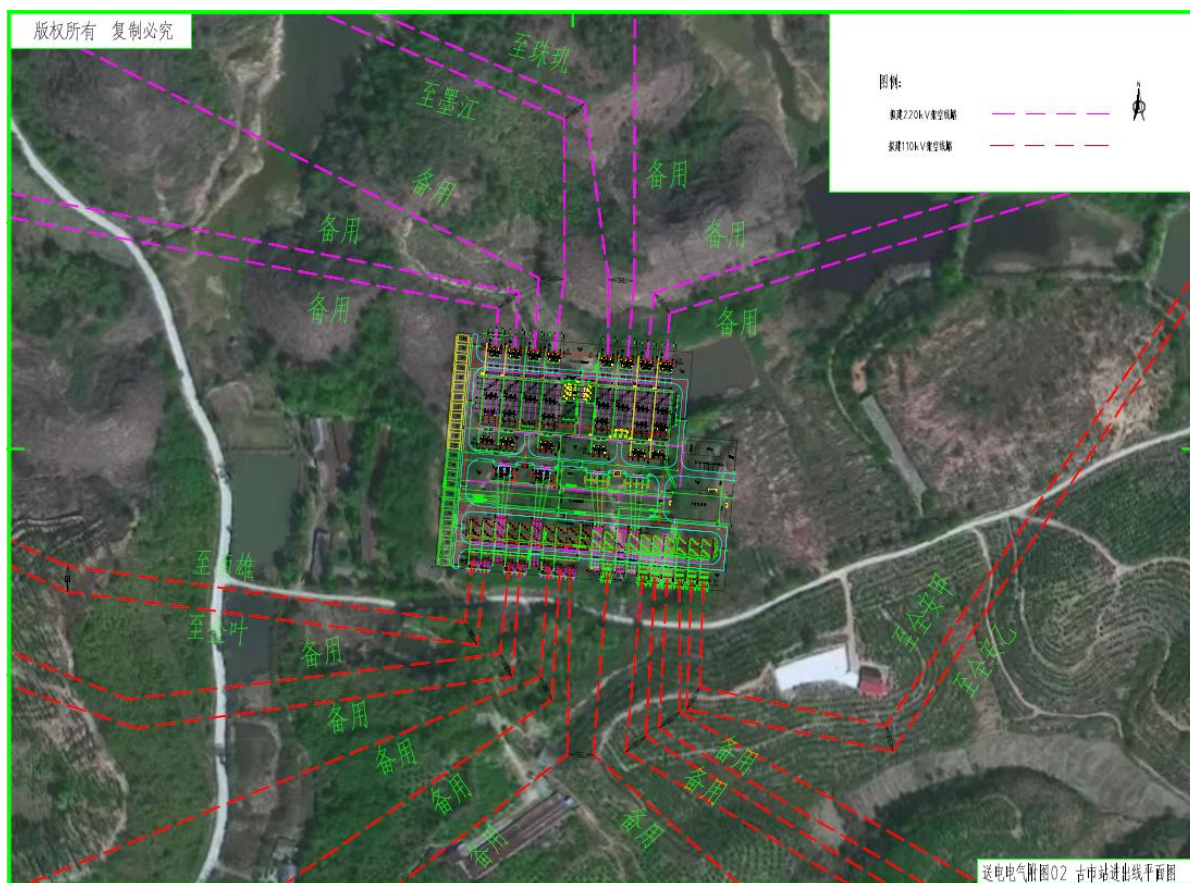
拟建 220kV 古市变电站平面布置示意图
